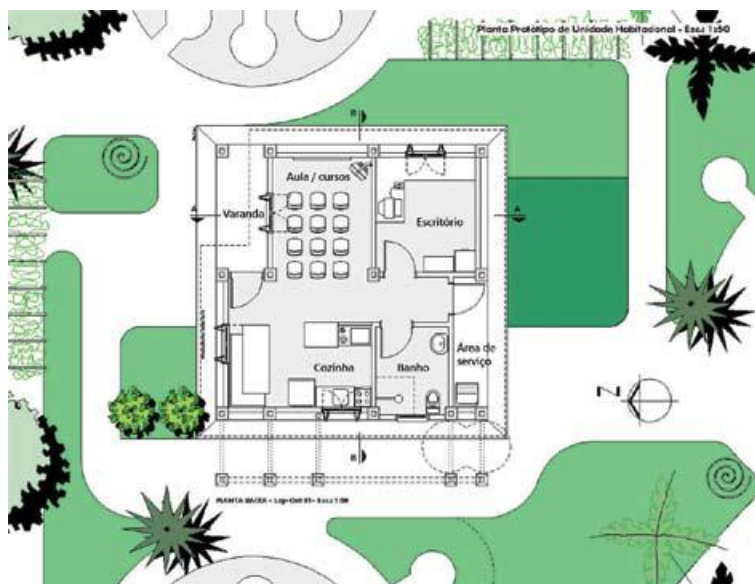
Planta baixa Casa Alvorada. Fonte: Sattler, 2009.
